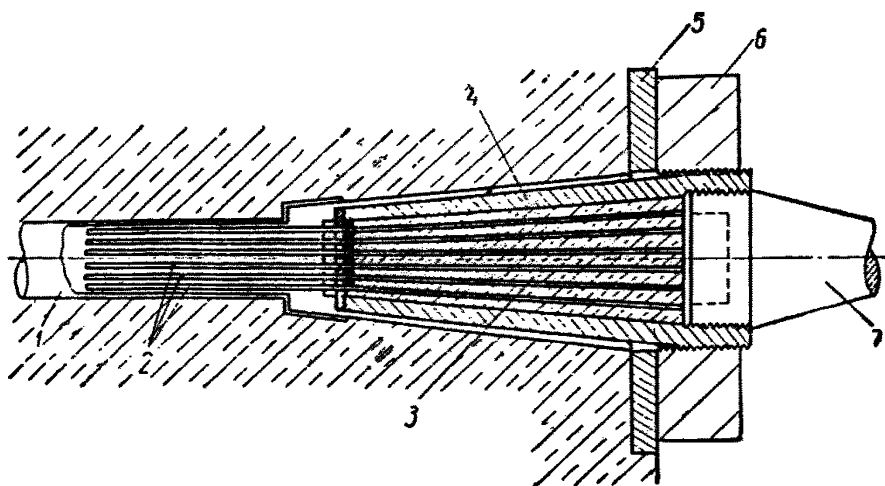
Анкеровка арматурного пучка из проволоки периодического профиля при помощи стального конуса
